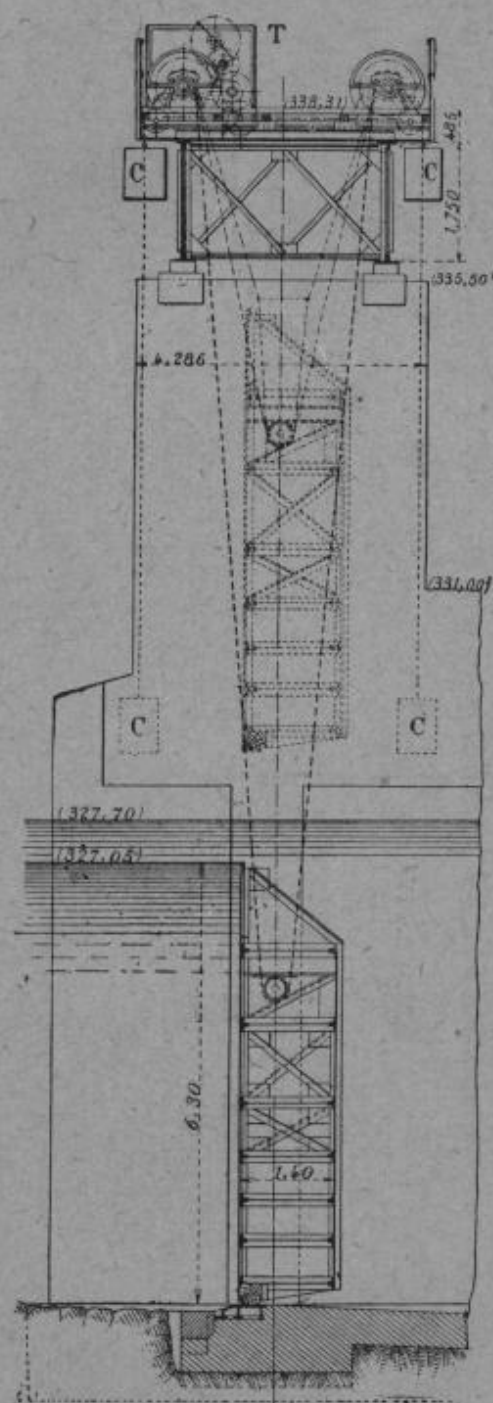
Coupe transversale du barrage sur l'Aar, montrant une vanne Stoney et son treuil.
